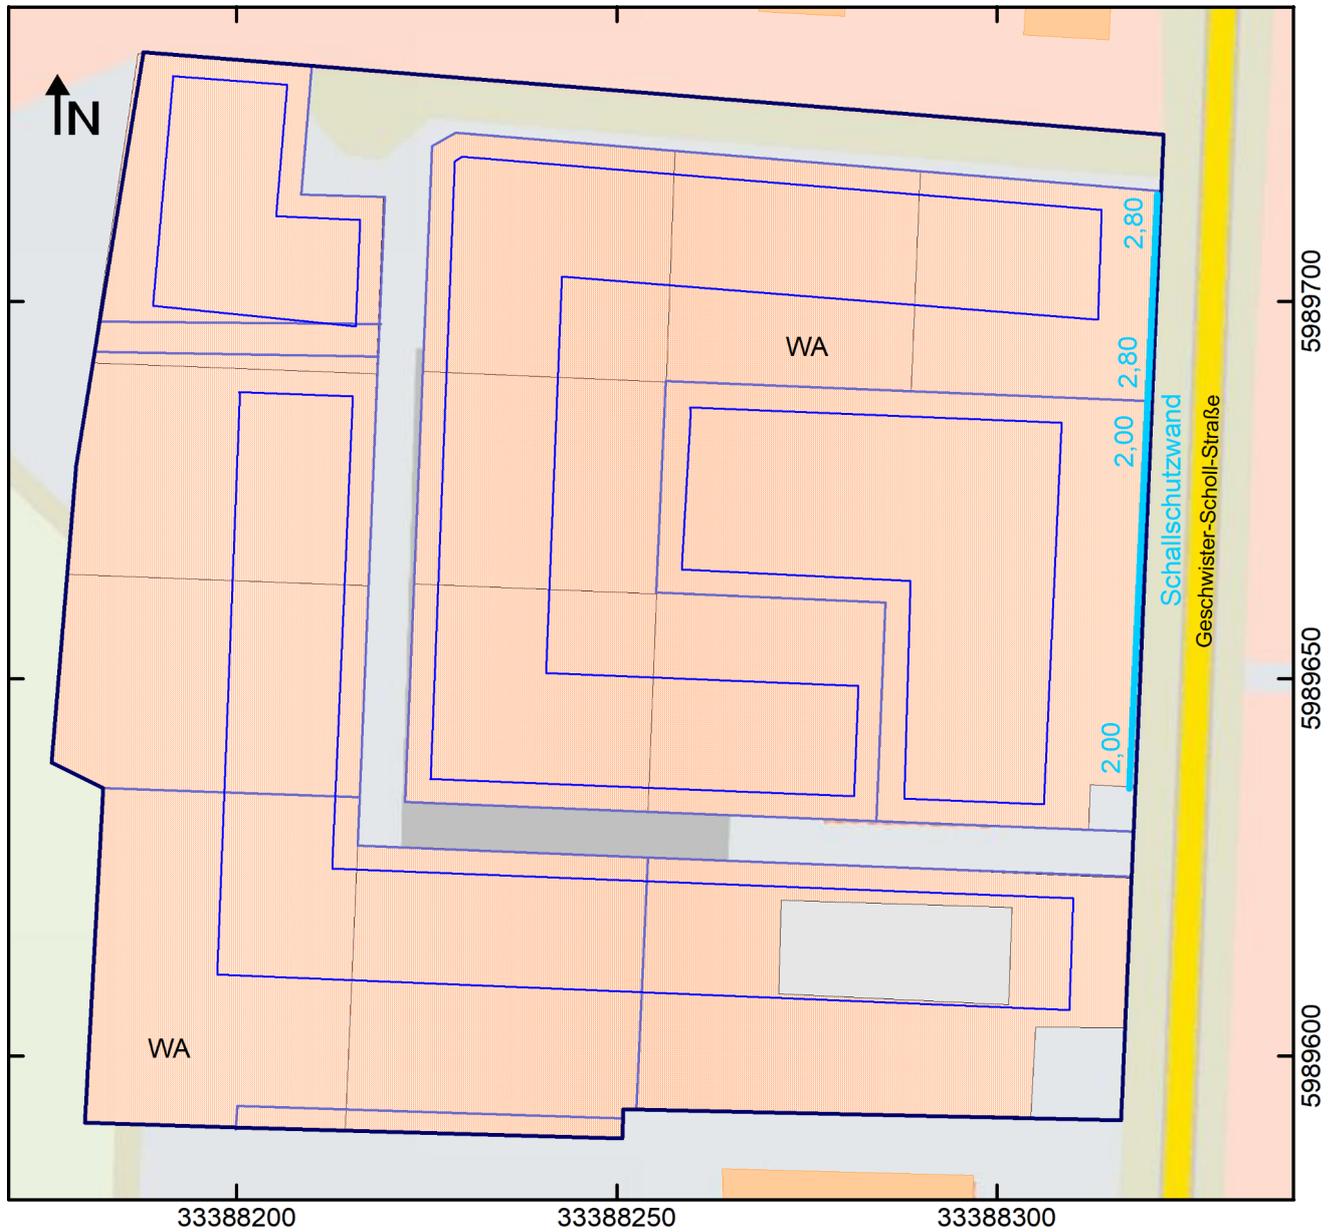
Position und Höhenangaben einer Schallschutzwand parallel zur Geschwister-Scholl-Straße (L 261)
